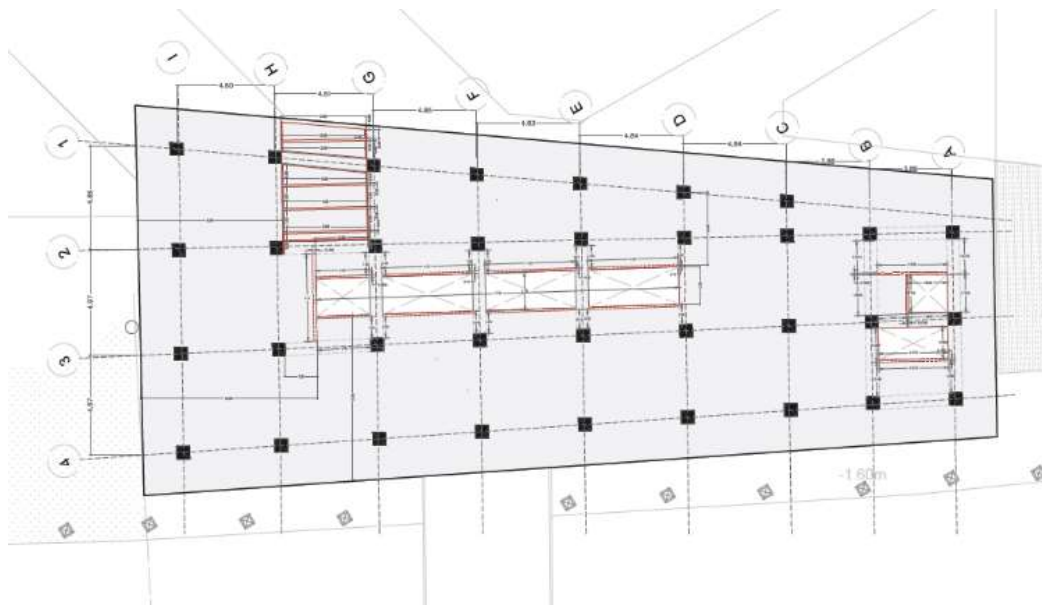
Planta Replanteo, (Elaborado por Loján, 2020)
